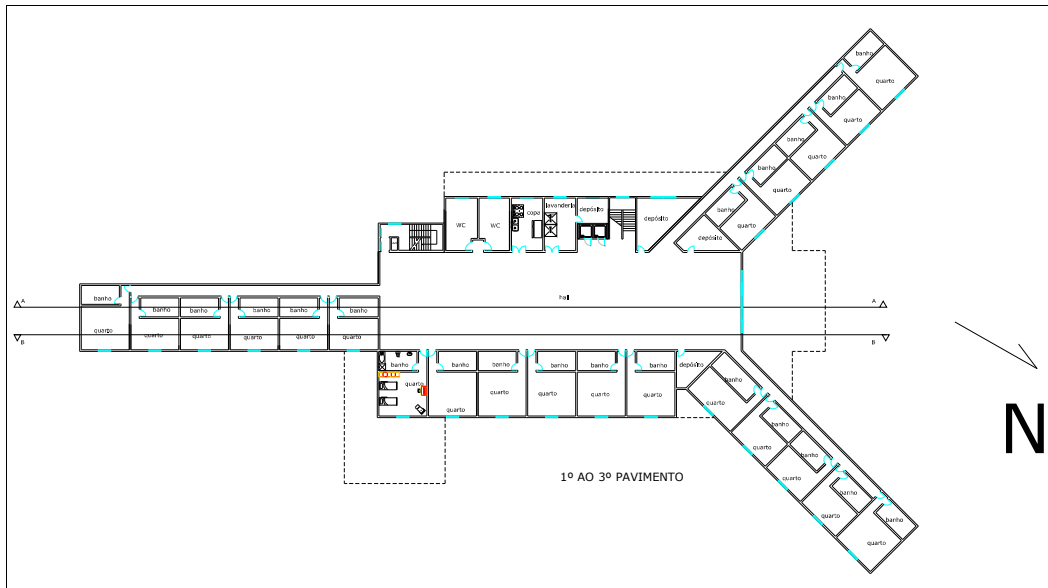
Planta do 2º pavimento do Projeto “B” (s/esc.)
